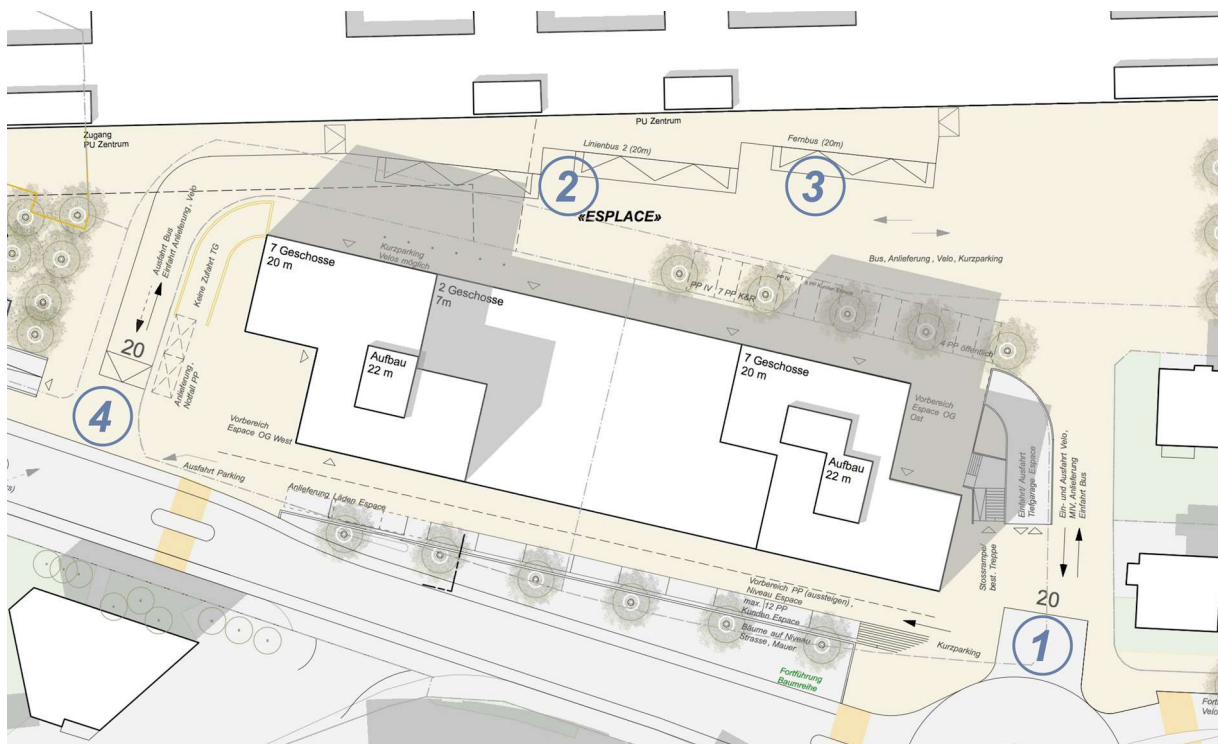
Ausschnitt Situationsplan mit Buserschliessung
